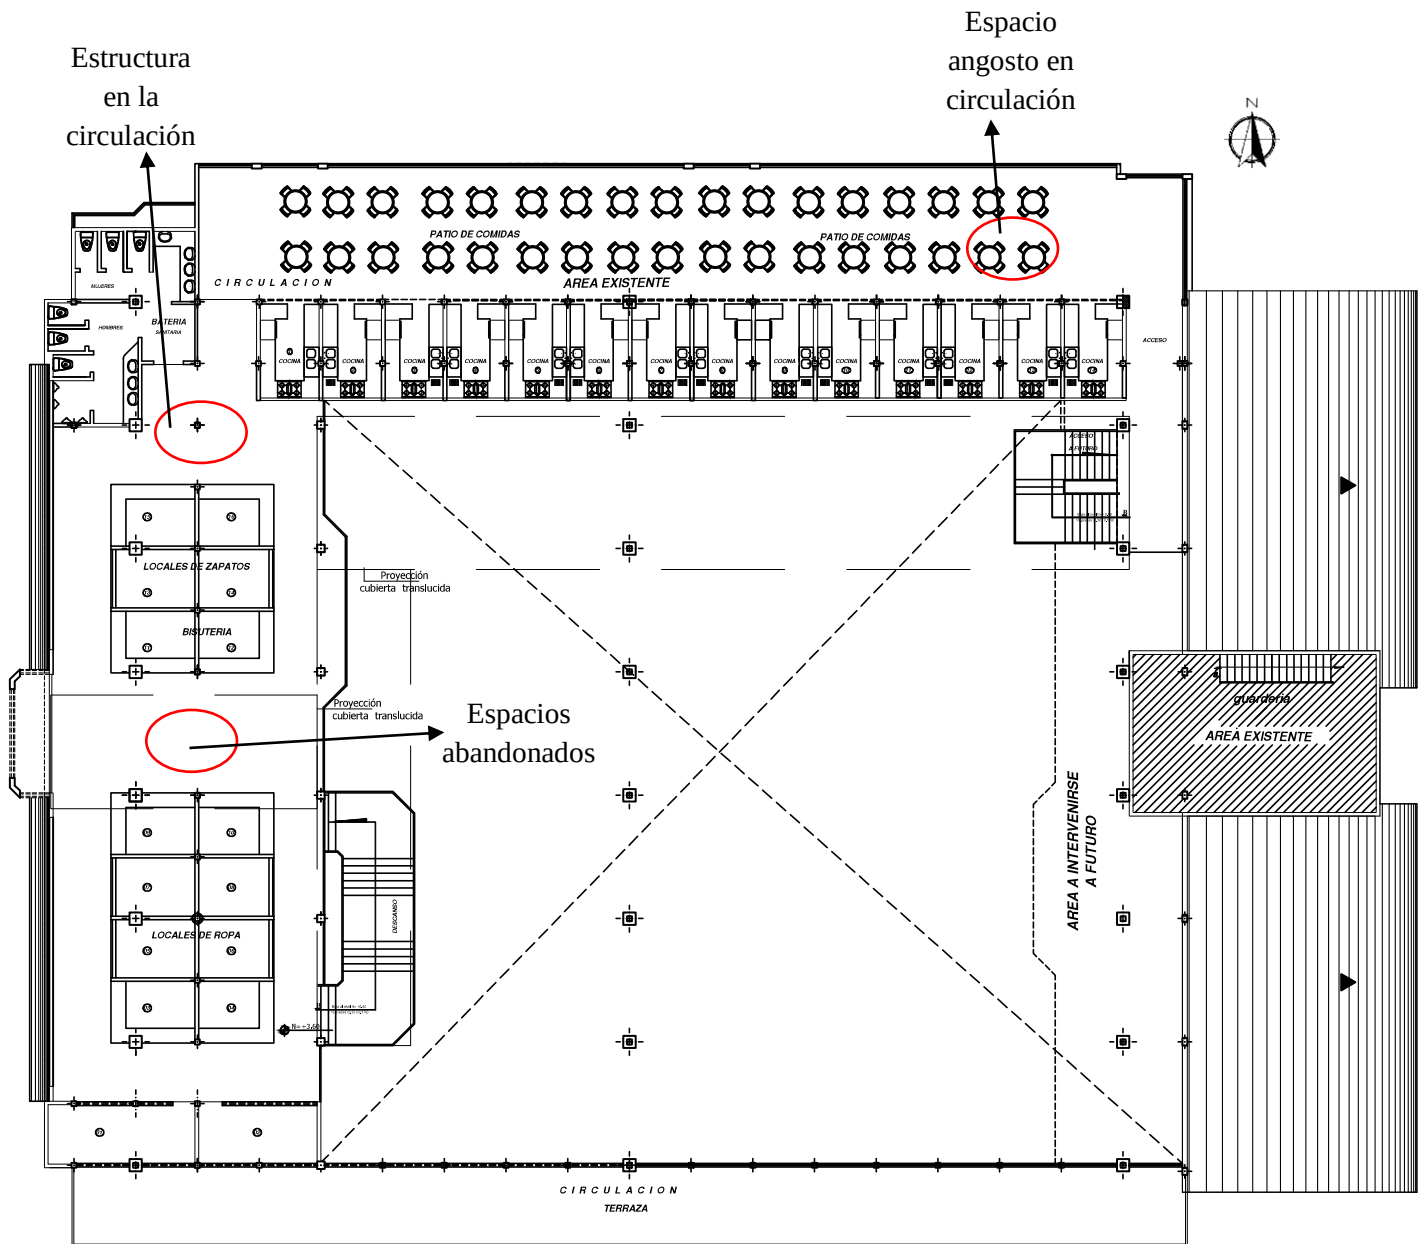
Planta arquitectónica N+0.40 mercado “Mariscal”
